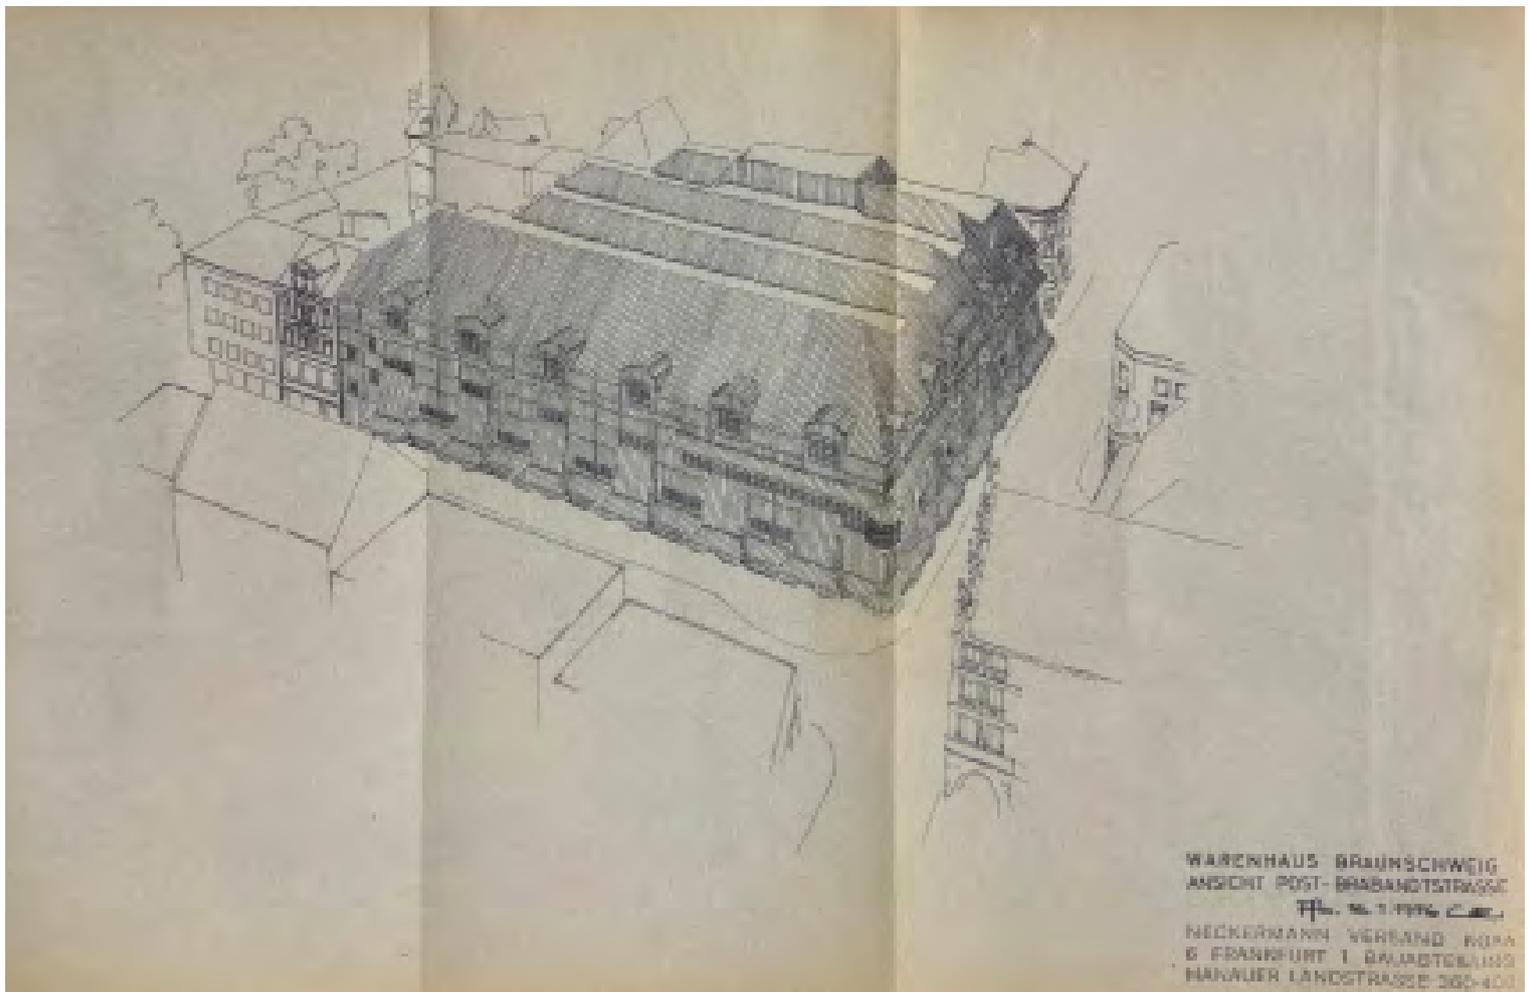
Ansicht Poststraße/ Brabandtstraße, Bauantrag 1976
